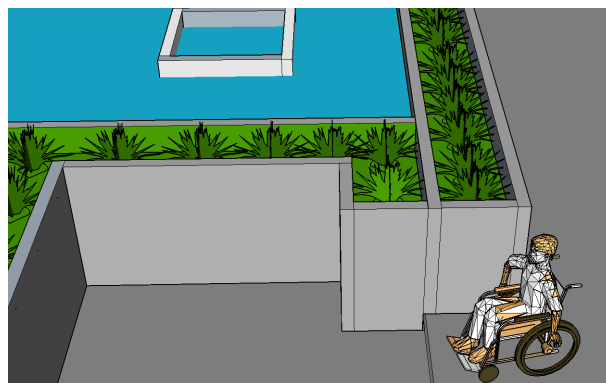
Barreiras não encontradas no pavimento térreo. Fonte: autora.
